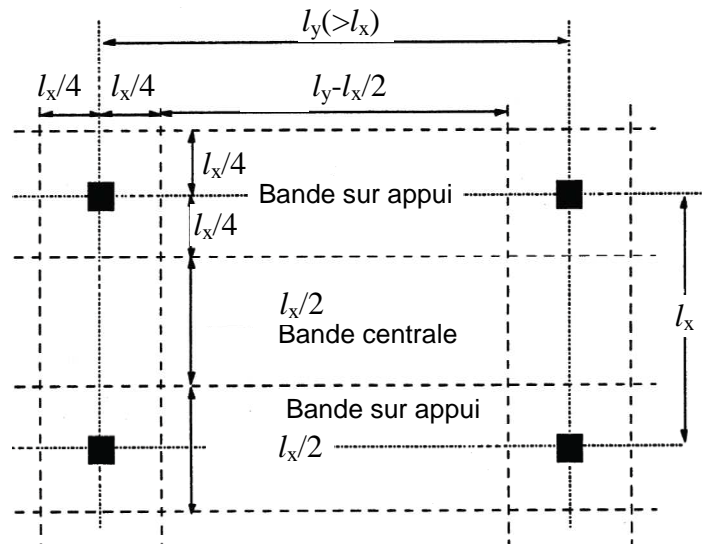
(EC2-1-1, Fig. I.1) : Division des panneaux de planchers-dalles.
